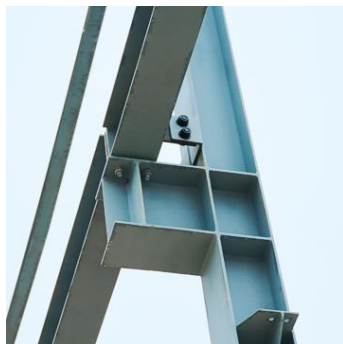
Крепление подкрановых путей на высокопрочное болтовое соединение с возможностью демонтажа.
